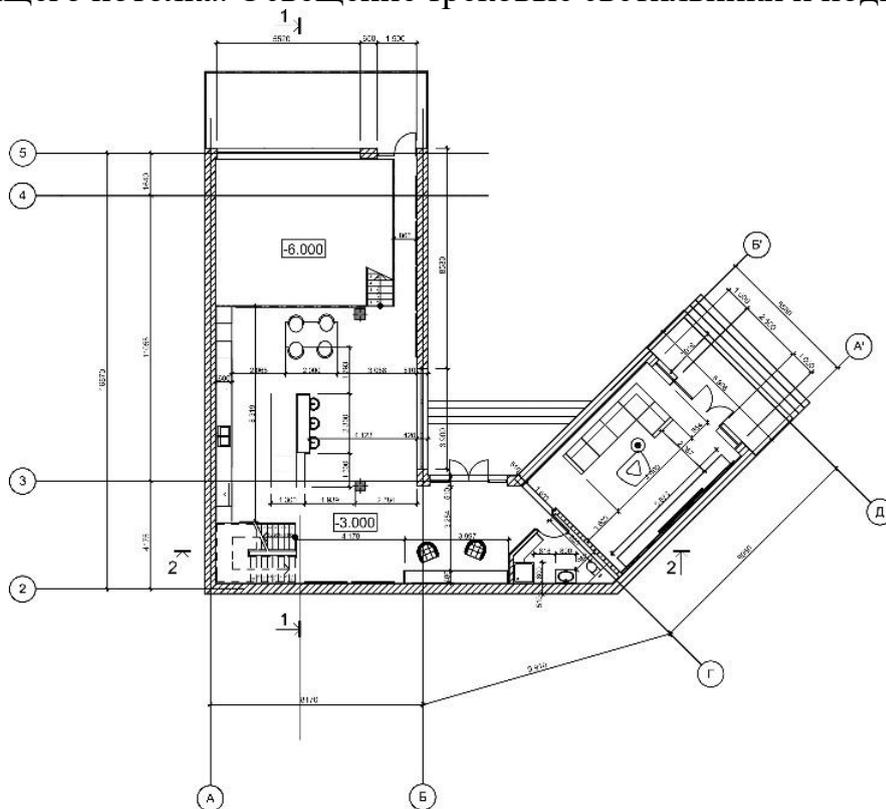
План -1-го этажа с расстановкой мебели на отметке -3.300
